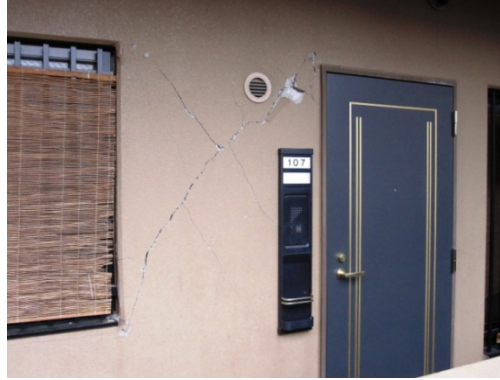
玄関横の非構造壁のせん断ひび割れ
